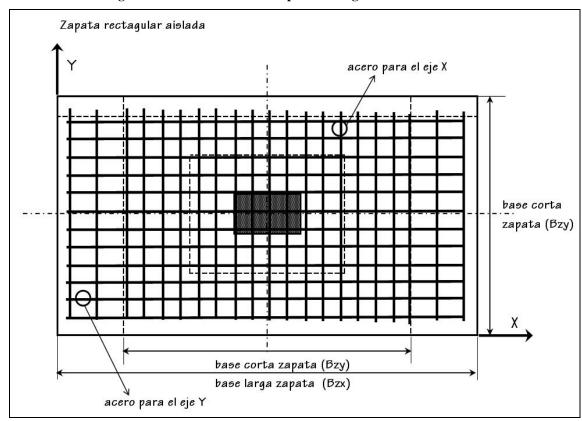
Detalles de armado zapata rectangular sin excentricidad
